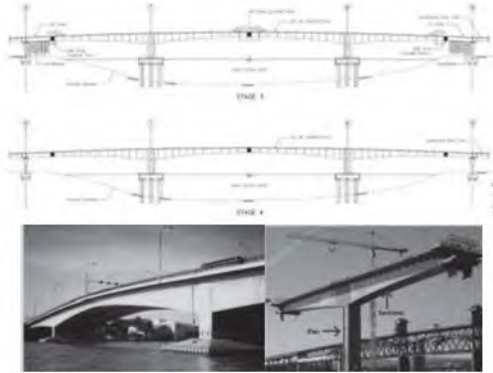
โครงสร้างสะพานแบบคานรูปกล่องชนิดหล่อในที่ (Cast-in-Place Concrete Box Girder)
